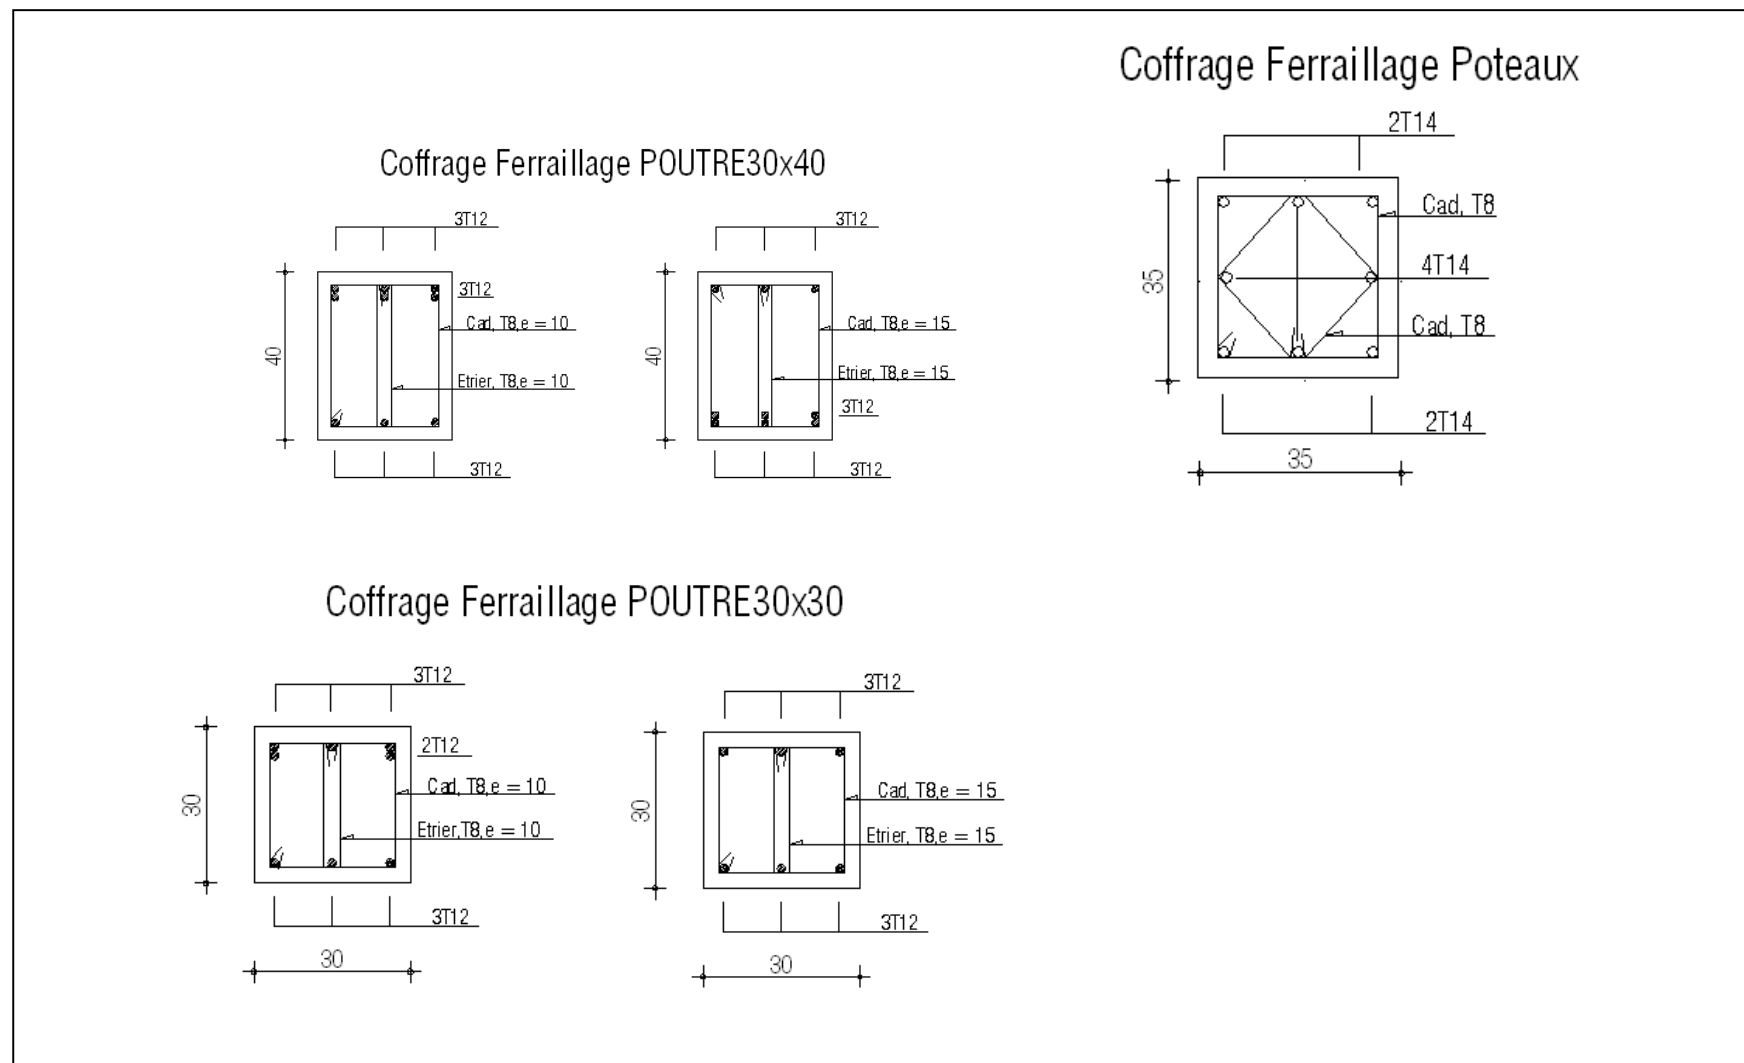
Ferrailade des éléments structuraux (poutres, voiles)
